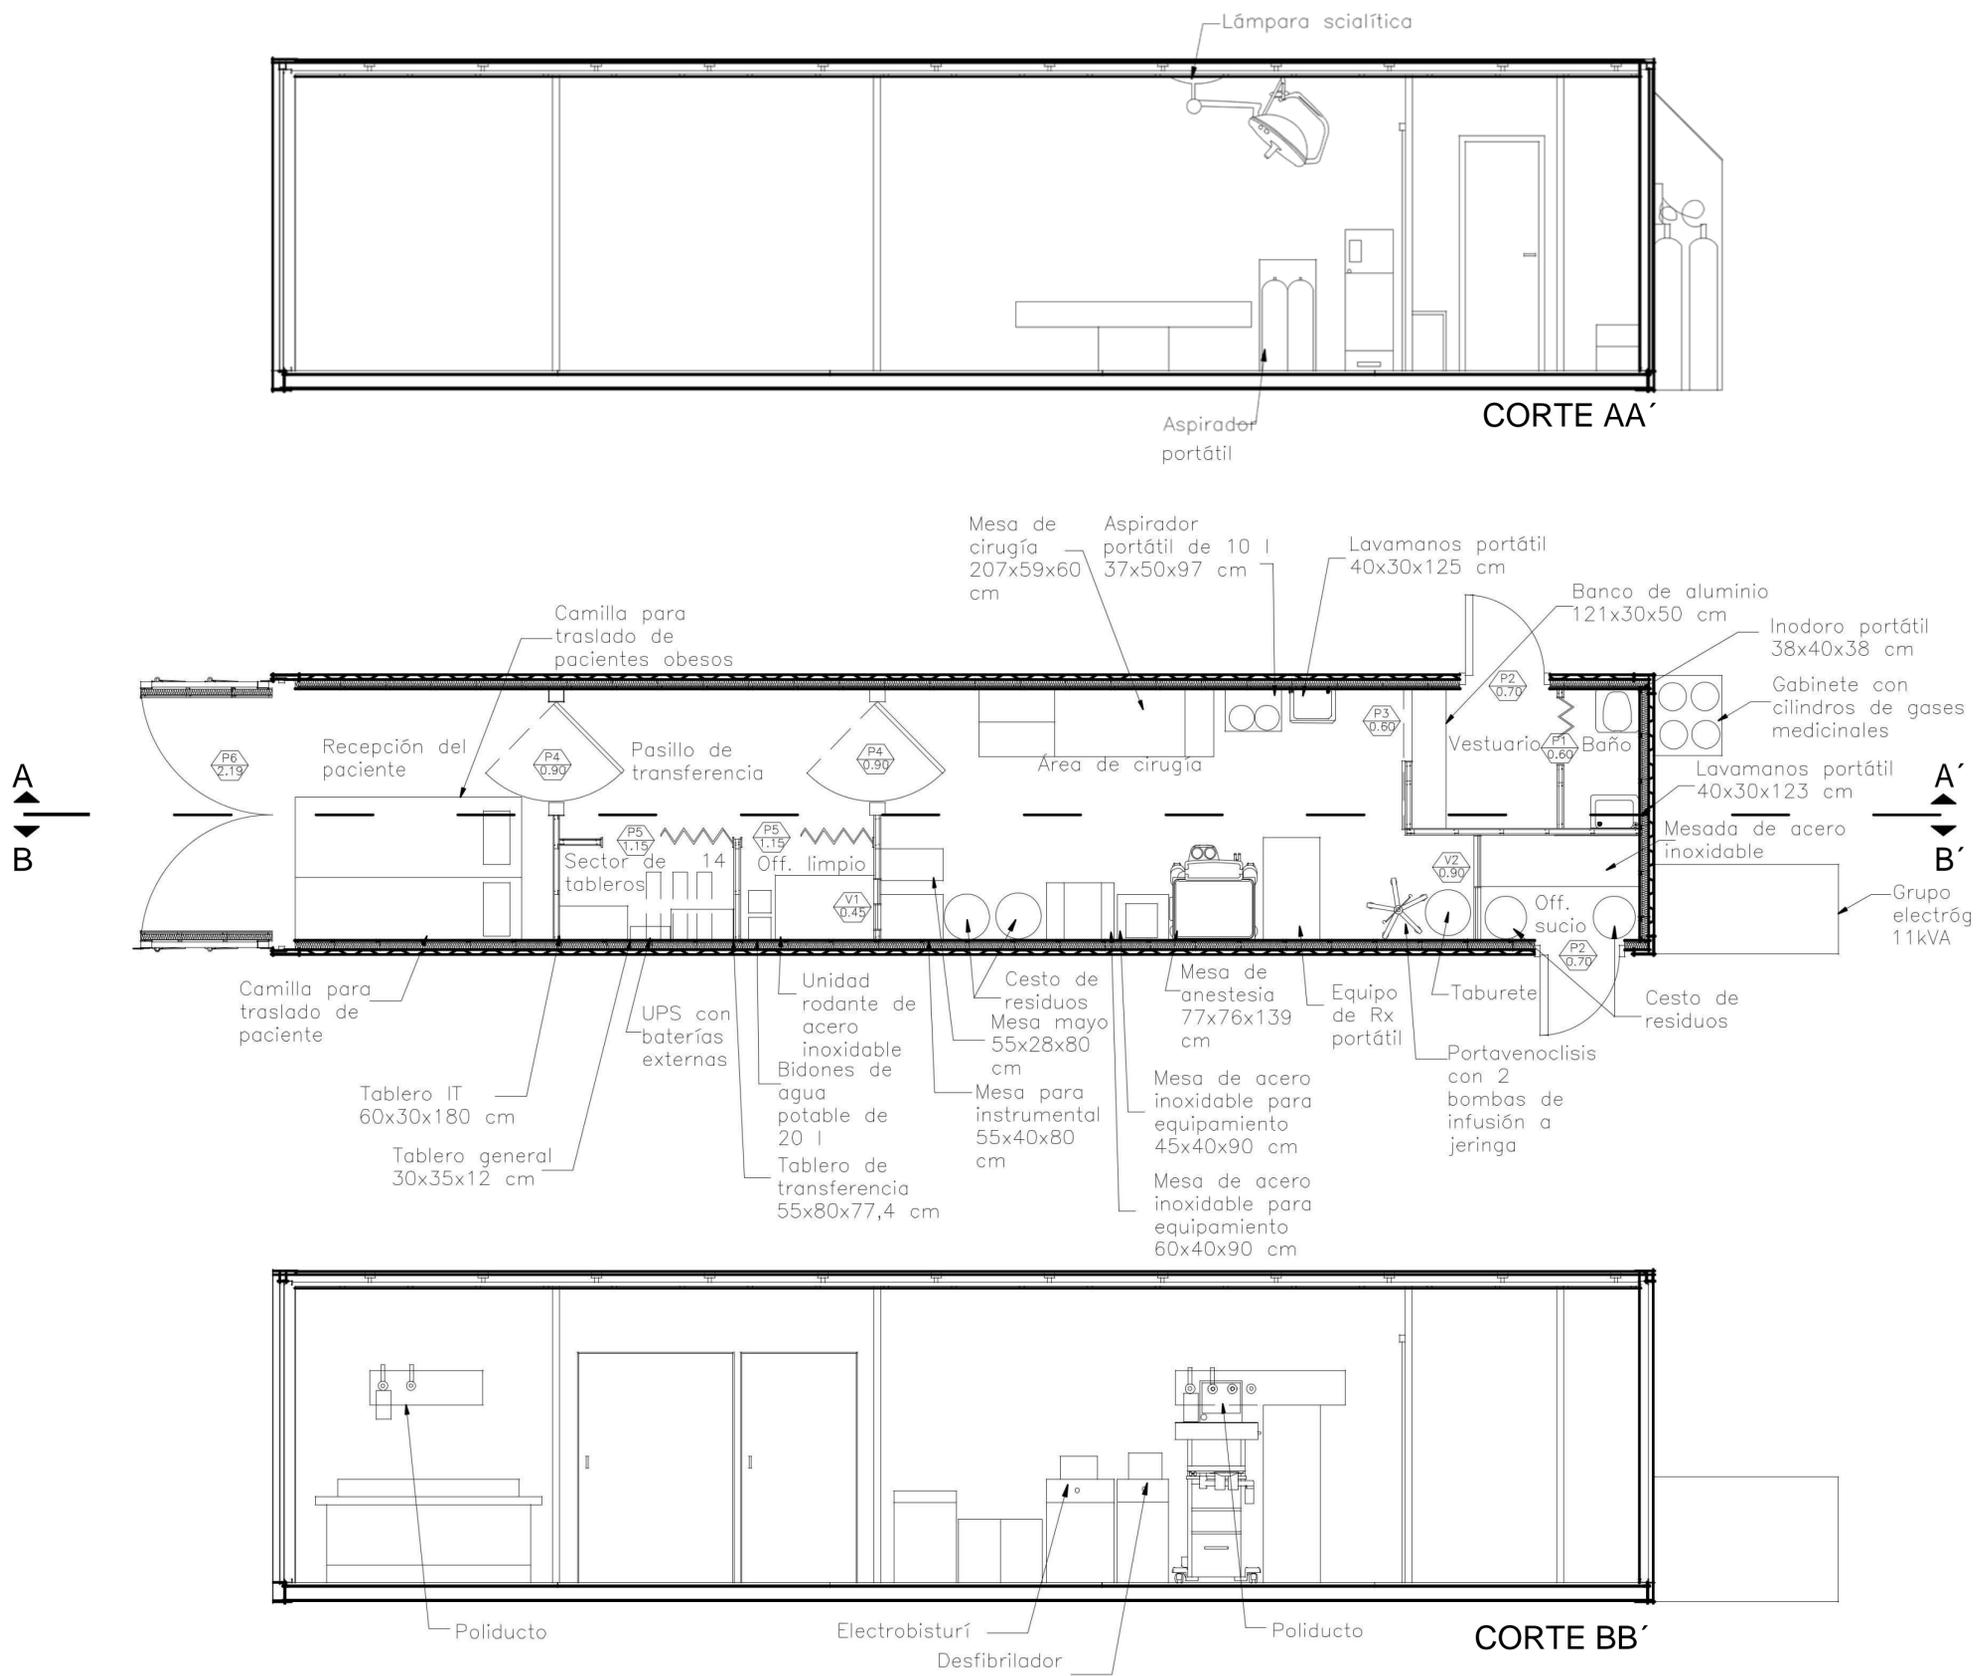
Plano de detalle de vista en planta y corte del bloque quirúrgico
